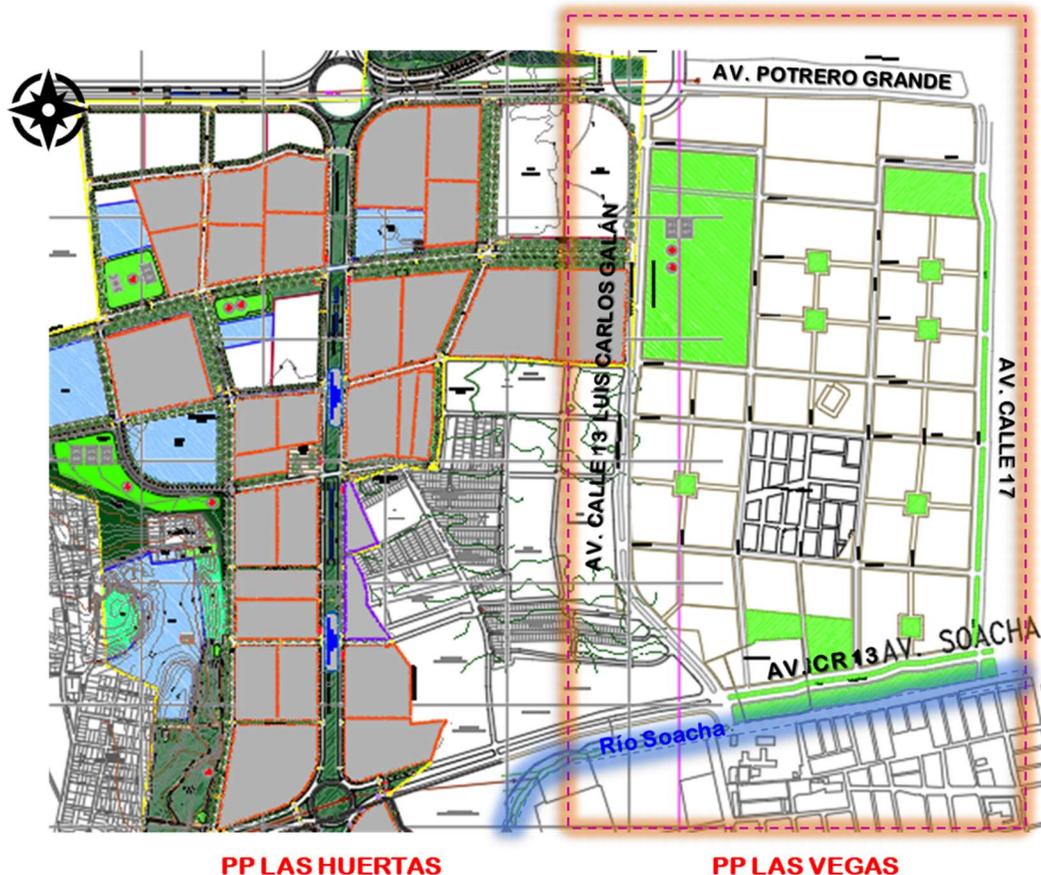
Plan vial plan parcial Las Vegas. Hogares Soacha.
